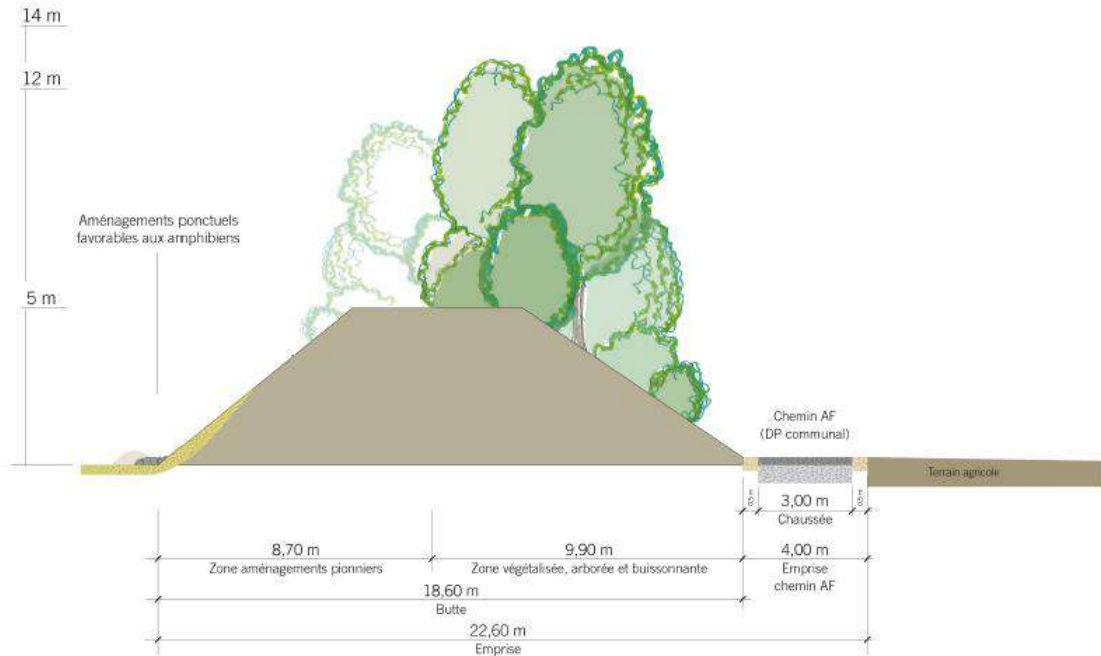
coupe schématique de la butte végétalisée (source : extrait du rapport 47 OAT sur la modification partielle des plans d'aménagement locaux de Coffrane et Montmollin, secteur « Rive », p. 110 ; Urbaplan, février 2023)
